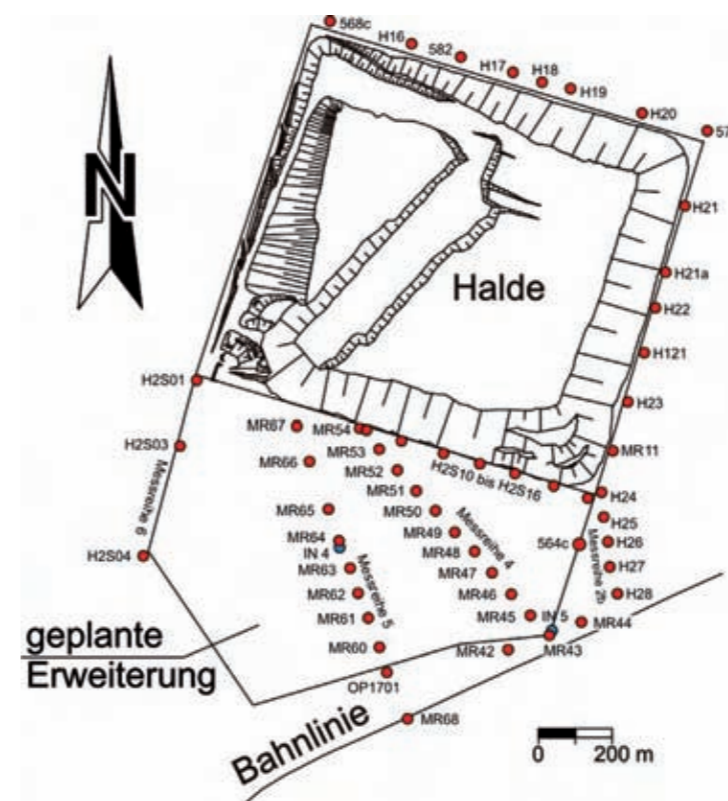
Lageplan des installierten Messprogramms / Site plan of tailings heap with observation points
